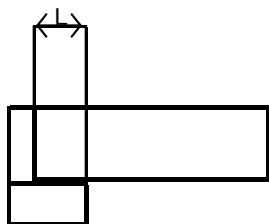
Длина опирания балок на береговой устой (L)
